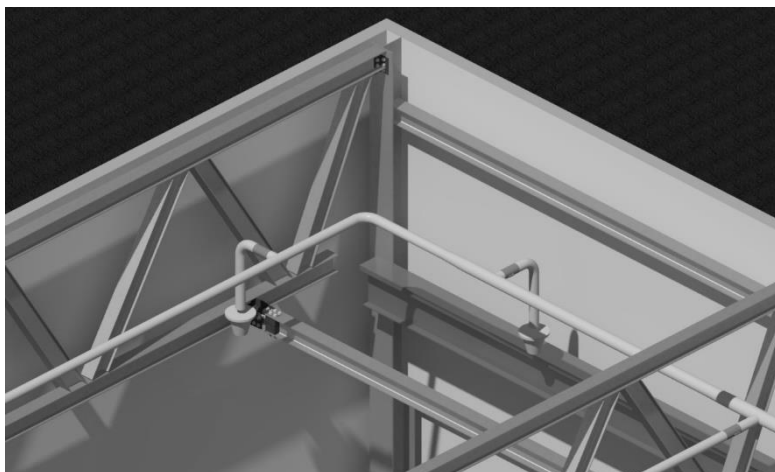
3-D модель производственного корпуса с инженерными сетями
